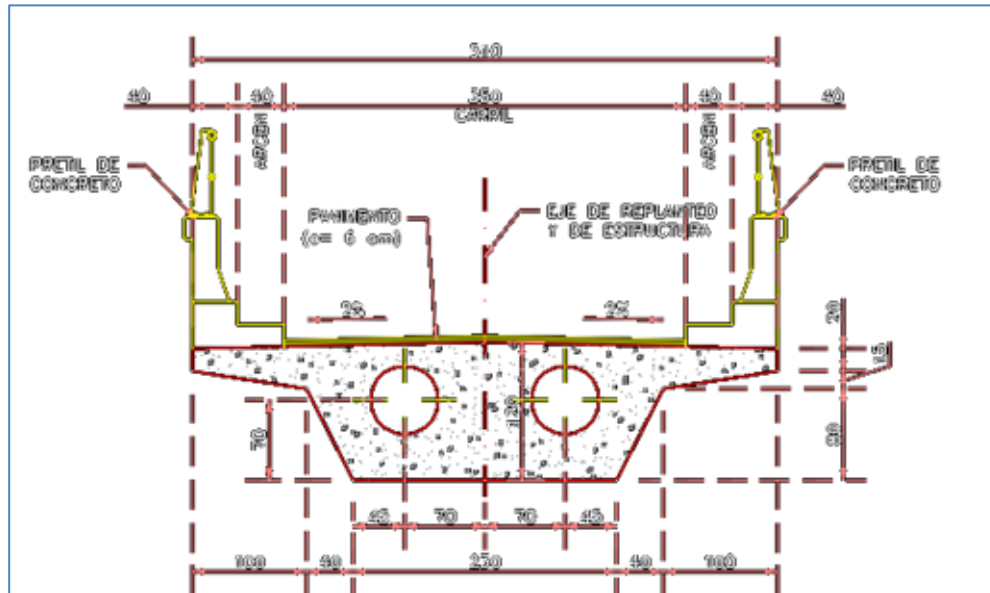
Losa de 1.2 m de canto y 5.1m de ancho.
